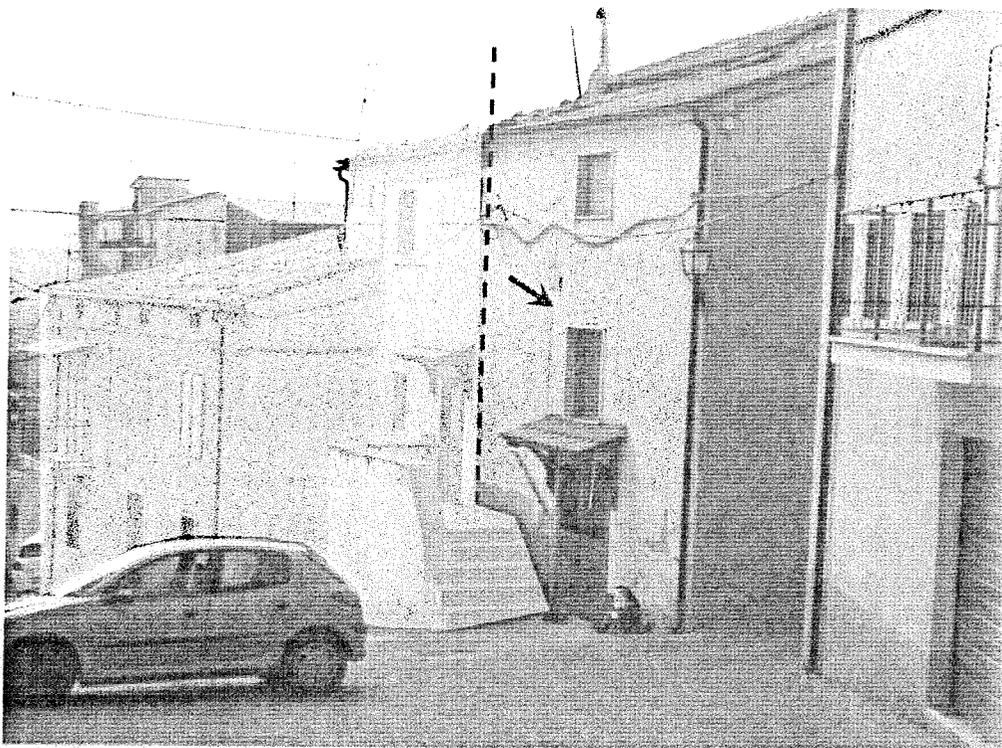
Fabbricato oggetto di causa. Ingresso lato sud cucina rustica al pian terreno su via indipendenza.
